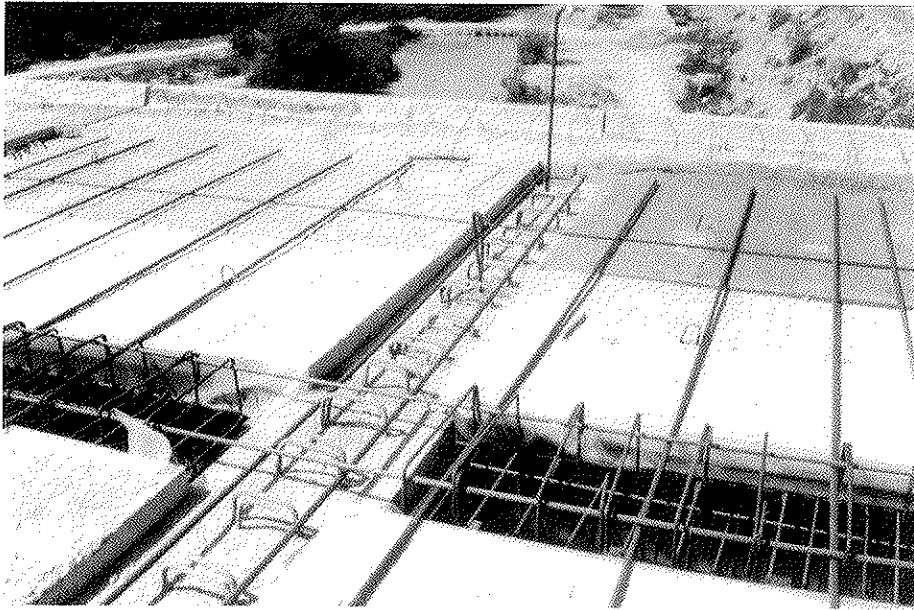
Placas prefabricadas apoyadas en nervios transversales.
